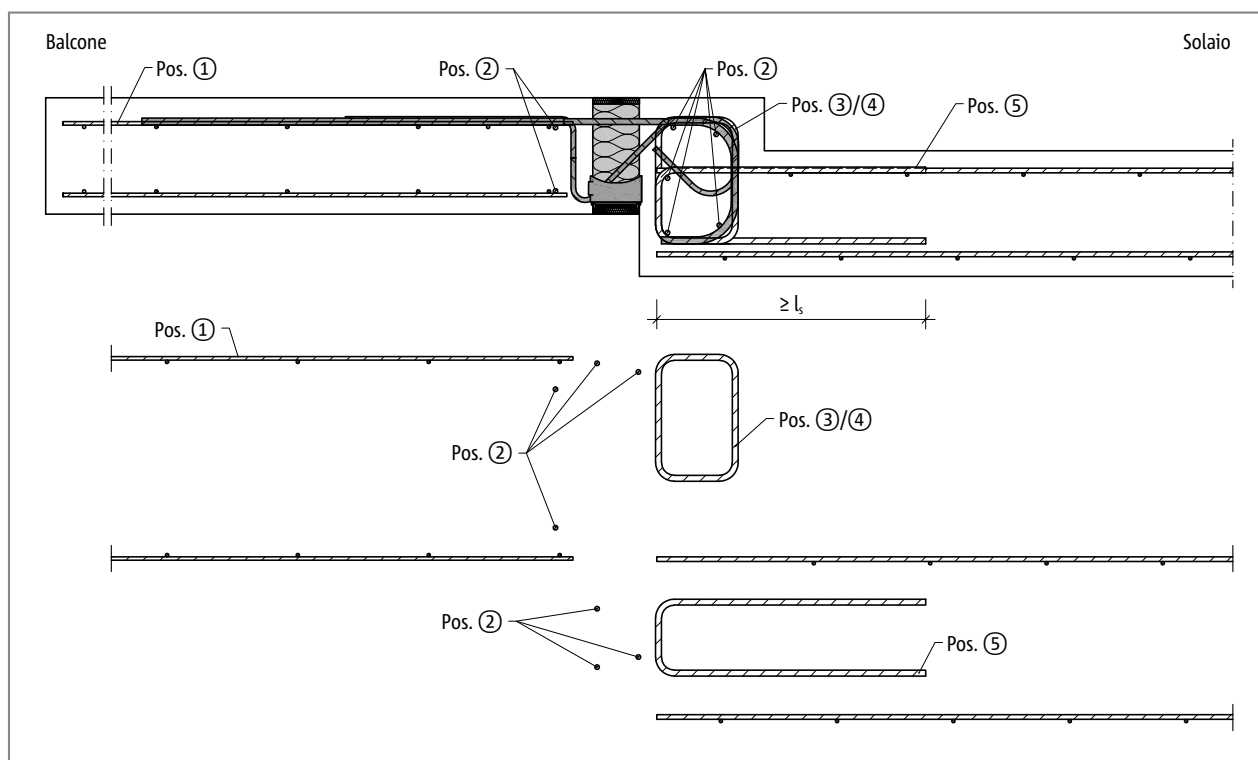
Schöck Isokorb® T tipo KL-O: armatura in opera
